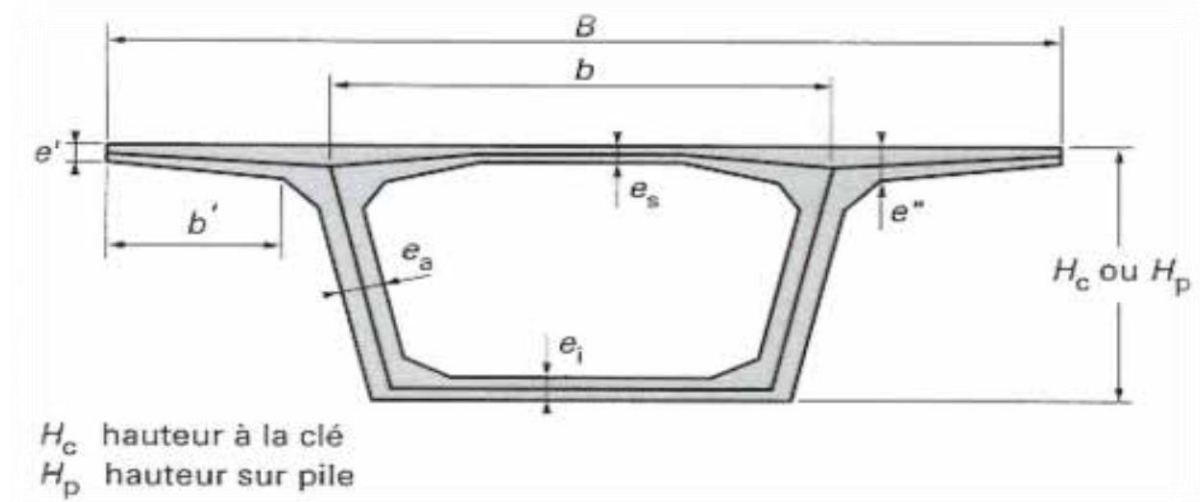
Coupe transversale d'un caisson unicellulaire
